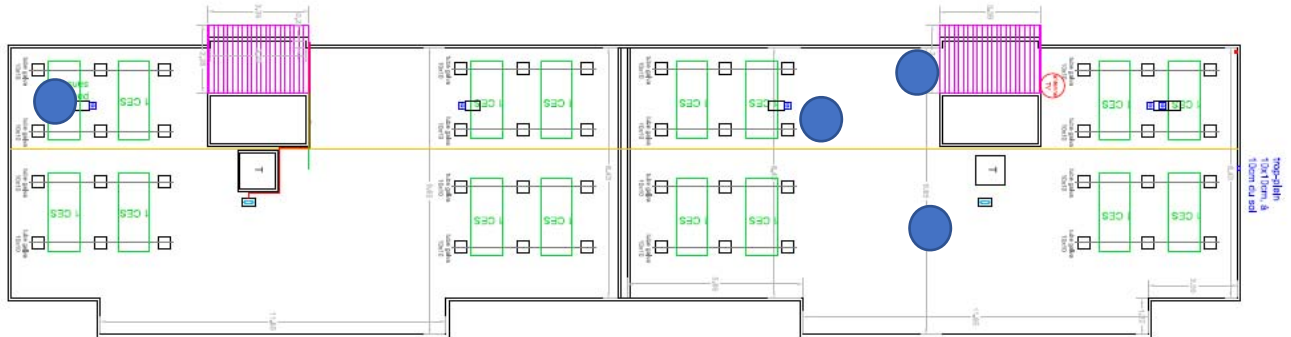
Extrait du plan de la toiture du bâtiment OPALE
